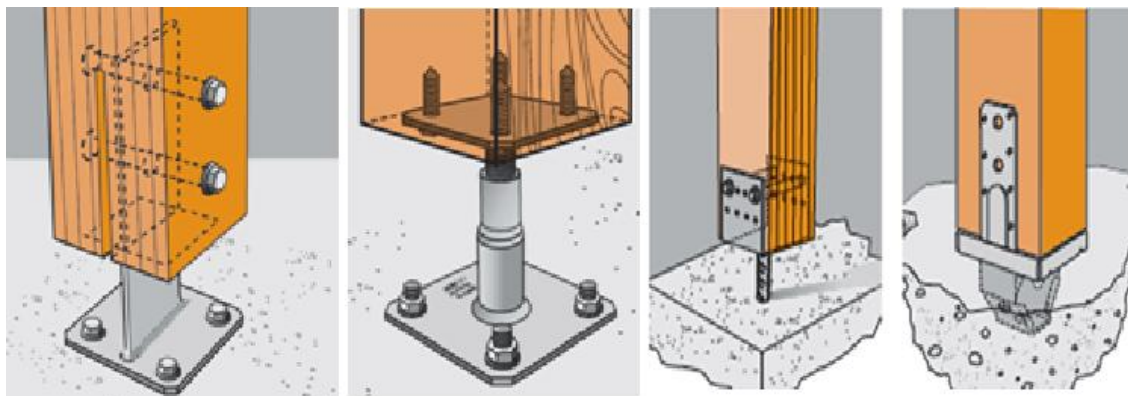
Exemplos de ligadores pilar-fundação para estruturas em MLC
